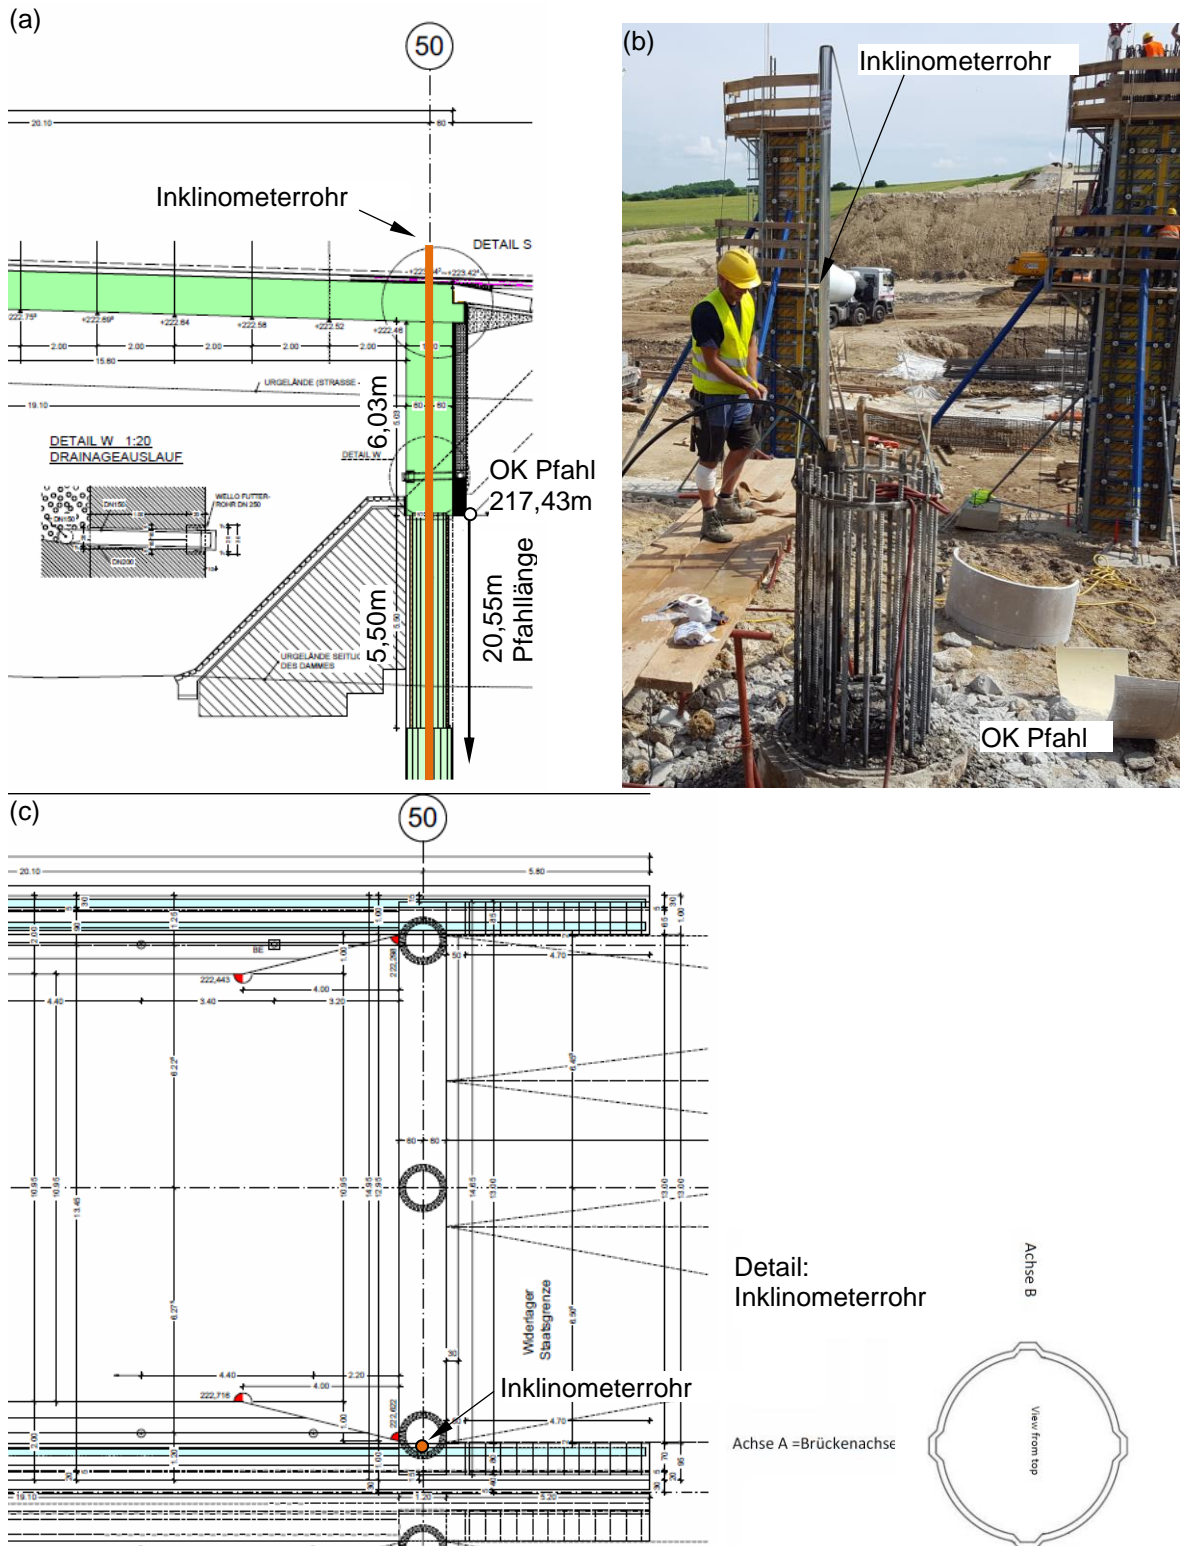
(a) Führung Inklinometerkur Achse 50, RFB Wien im Schnitt, (b) Detail beim Einbau Inklinomet und verpressen mit dem Stahlrohr in der Pfahlbewehrung und (c) Lage im Grundriss.
